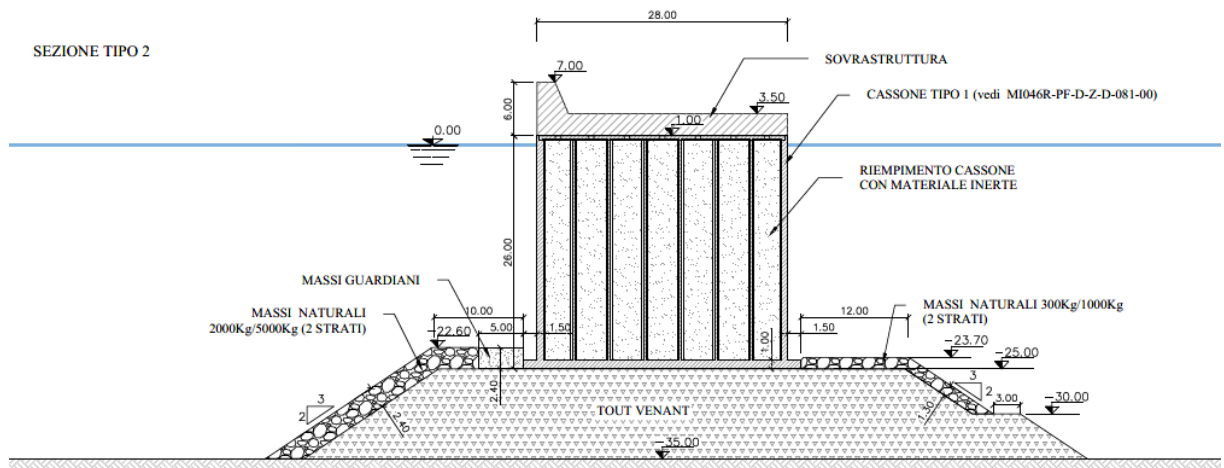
DIGA DI SOPRAFLUTTO - SEZIONE TIPO 2 (FONDALE MEDIO 35 M)
